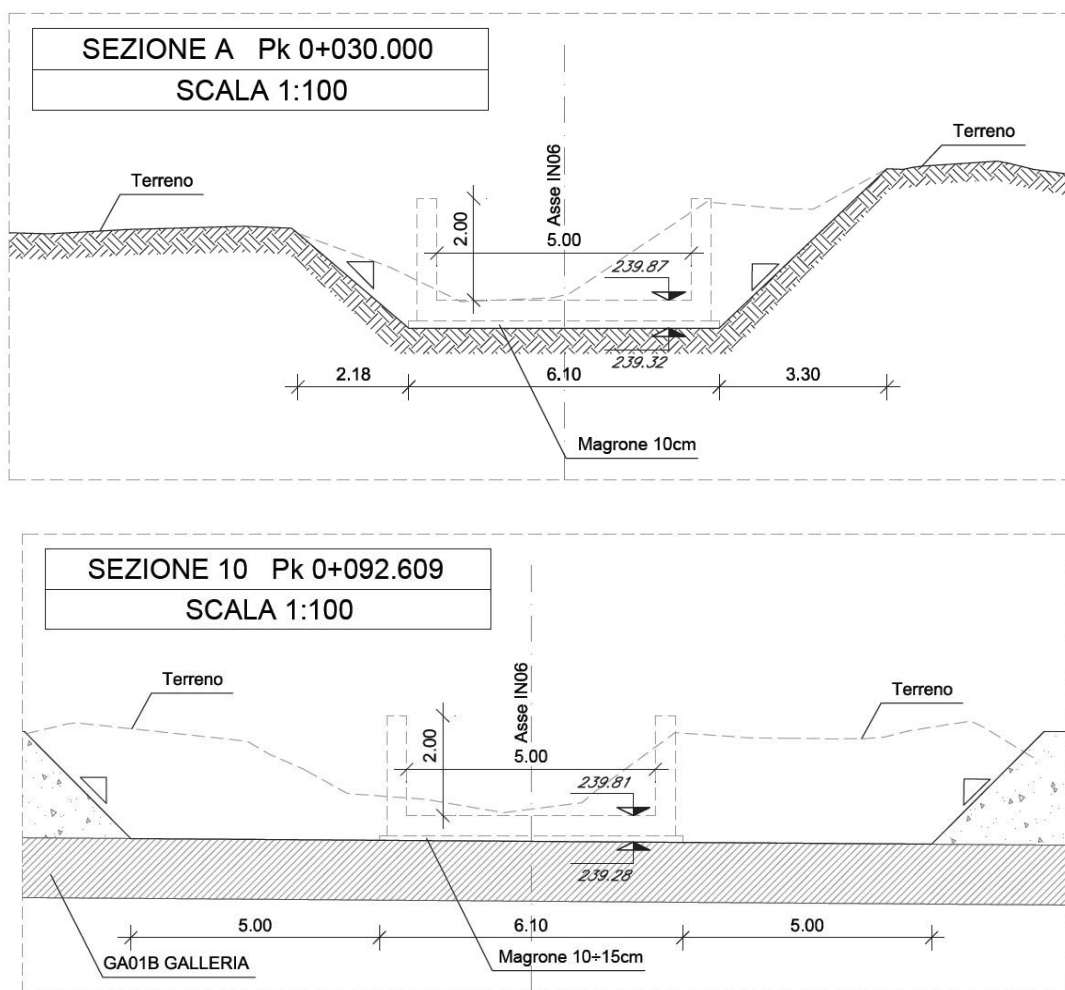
Sezione A e sezione 10 dell'opera IN06
